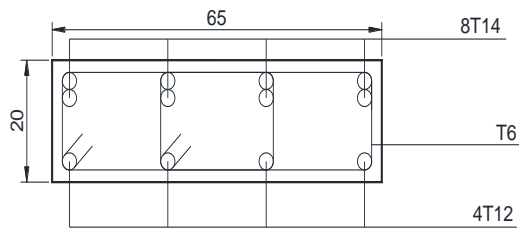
Coupe longitudinale d'une poutre noyée principale 65x20cm (plan irrégulier en élévation)
